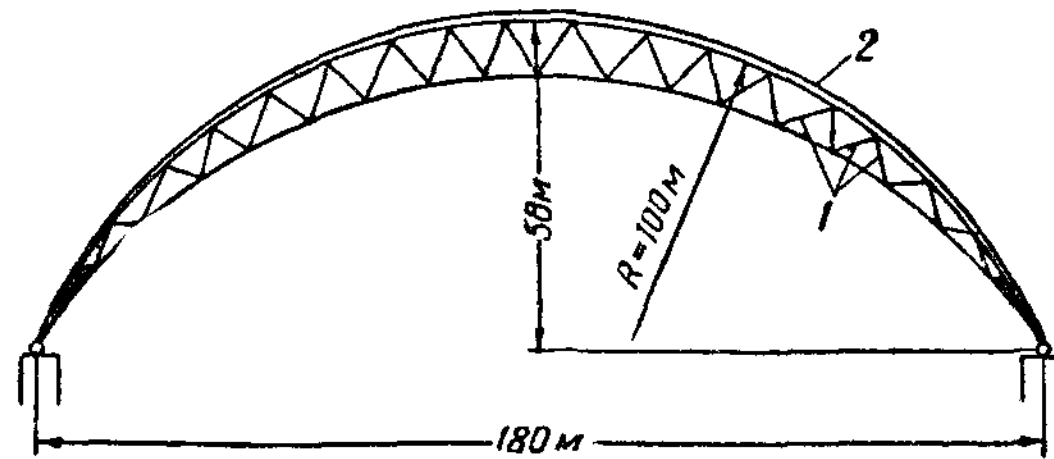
Предварительно напряженная арка с нижним поясом и решеткой из тросов (ГПИ Проектстальконструкция)
